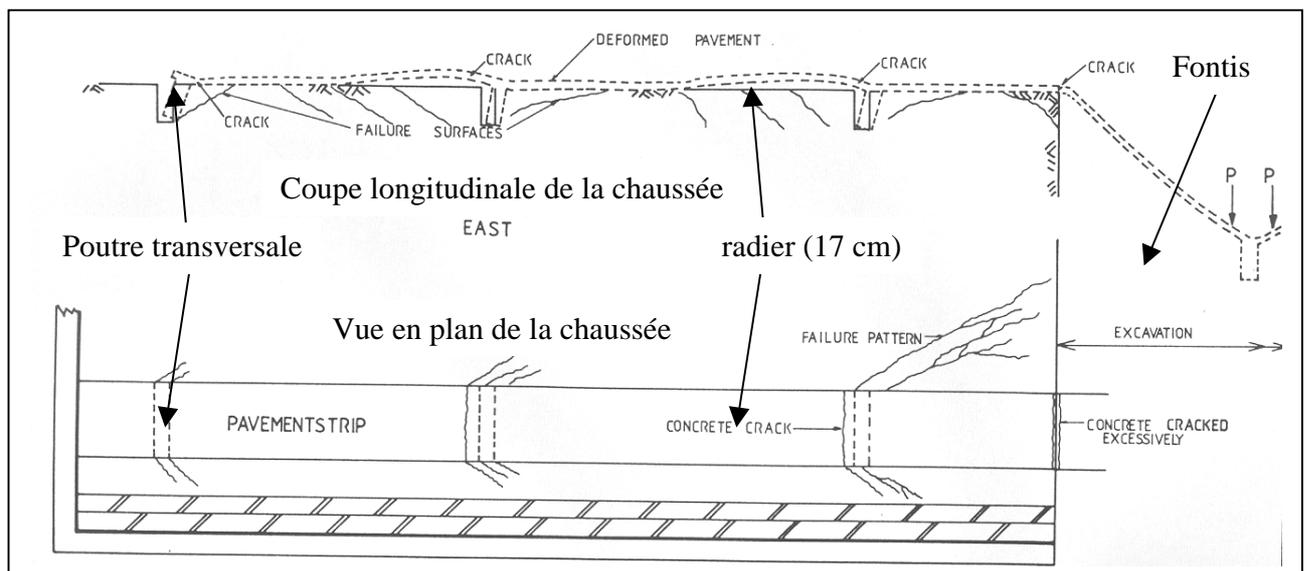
Illustration de la protection partielle d'une chaussée par un complexe radier - poutres transversales (Louw et al. 1984).
